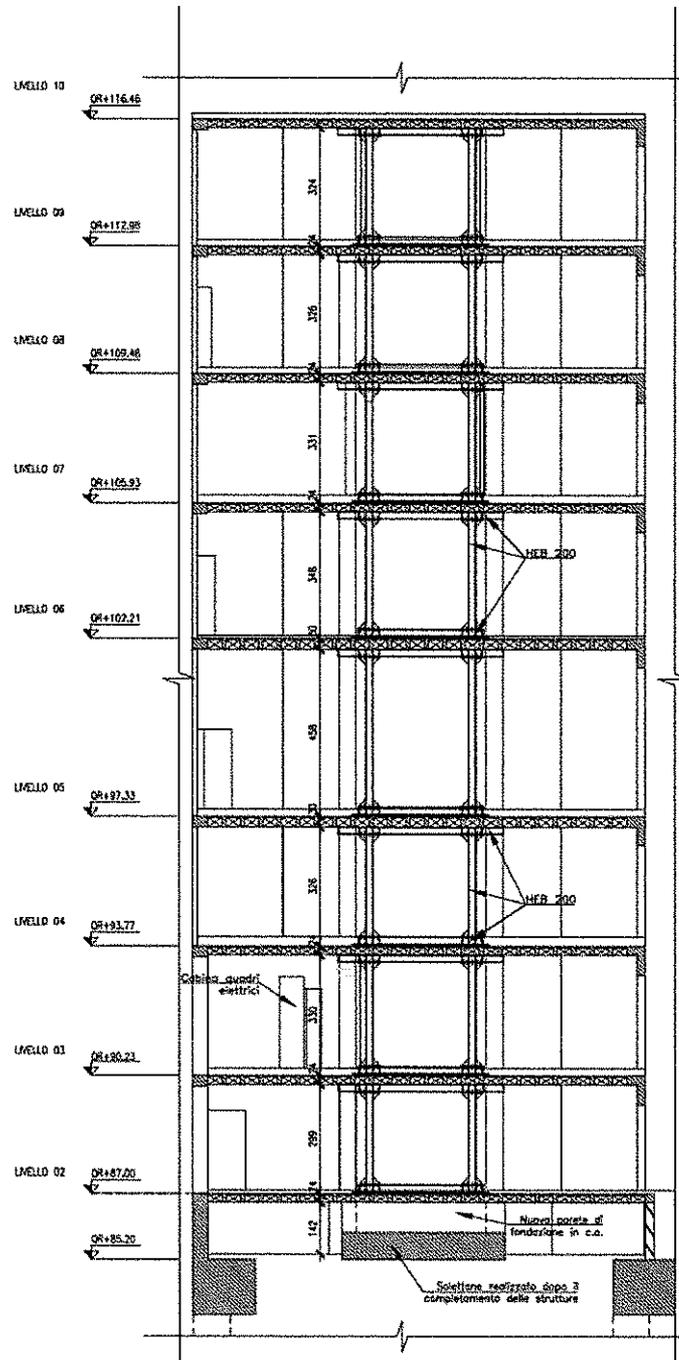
Nodo E - F – Sezione B-B - Vista dei telai di rinforzo
